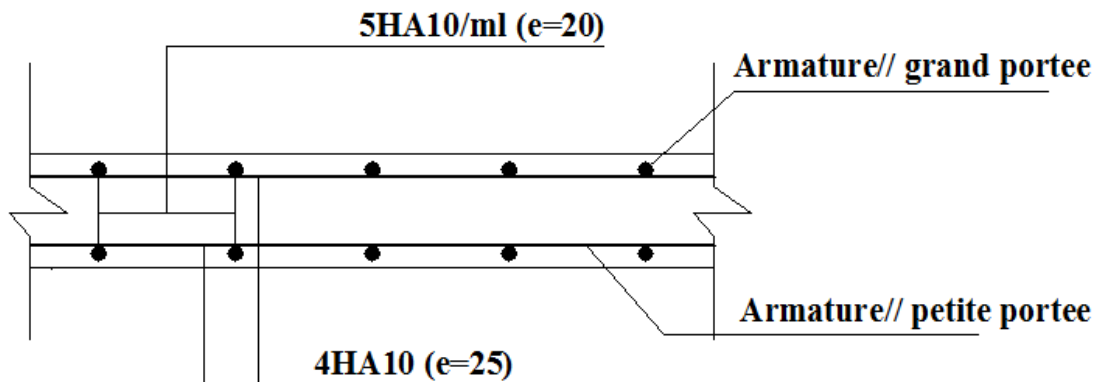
Ferrailage de la dalle pleine (salle machine)
